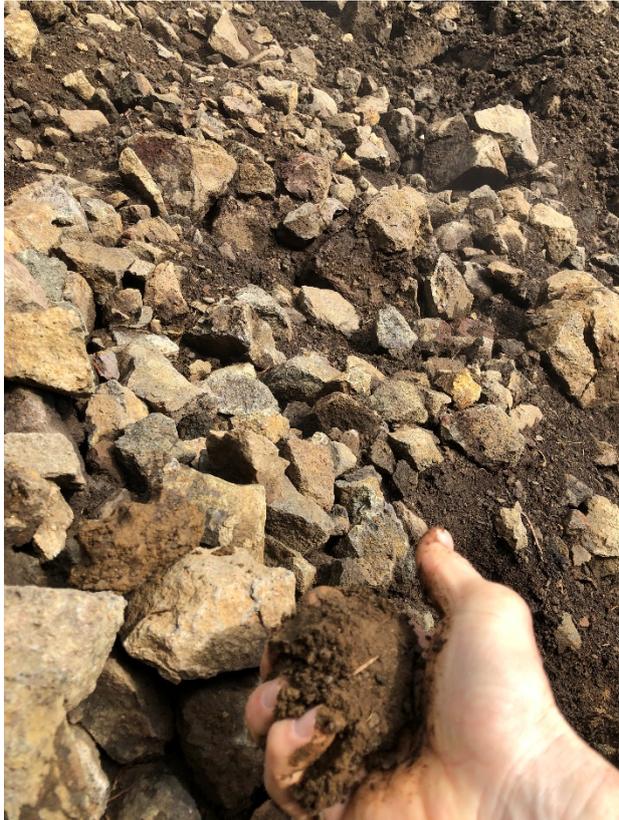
Verwitterungsschutt mit kantigen Steinen und leicht bindiger Matrix
